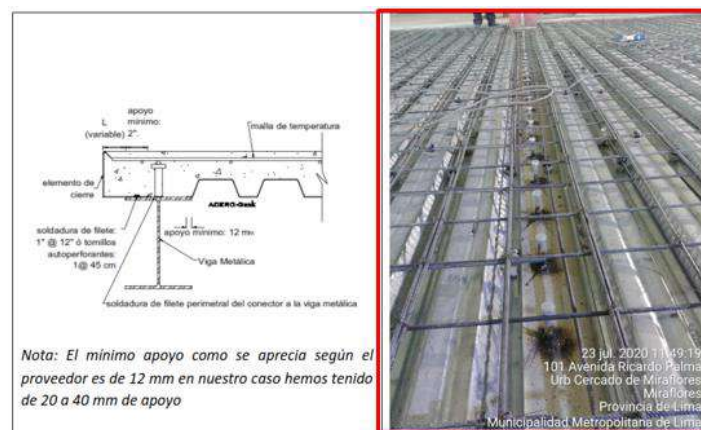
Apoyo de placa colaborante sobre viga tipo A
